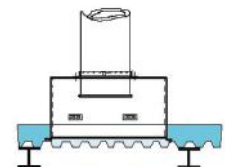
Collier de soutien réhaussé réf. 122 sur plancher béton et charpente métallique. Il sert de coffrage pour la trémie
